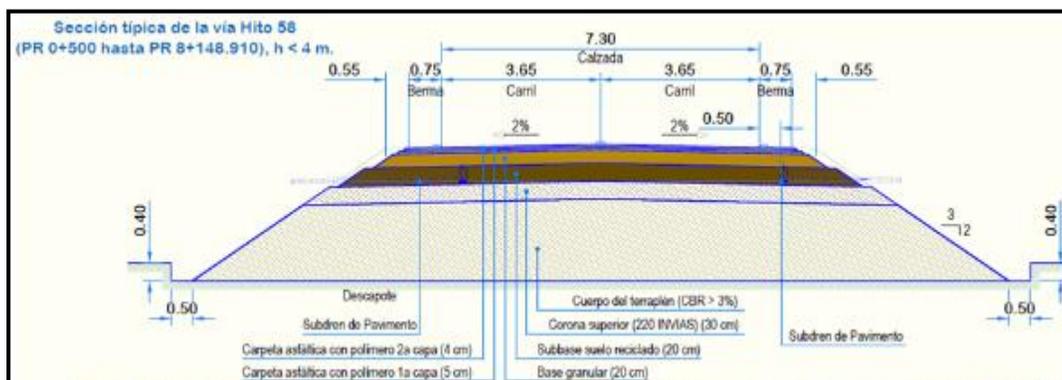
Estructura de Pavimento Aprobada Hito 58.
